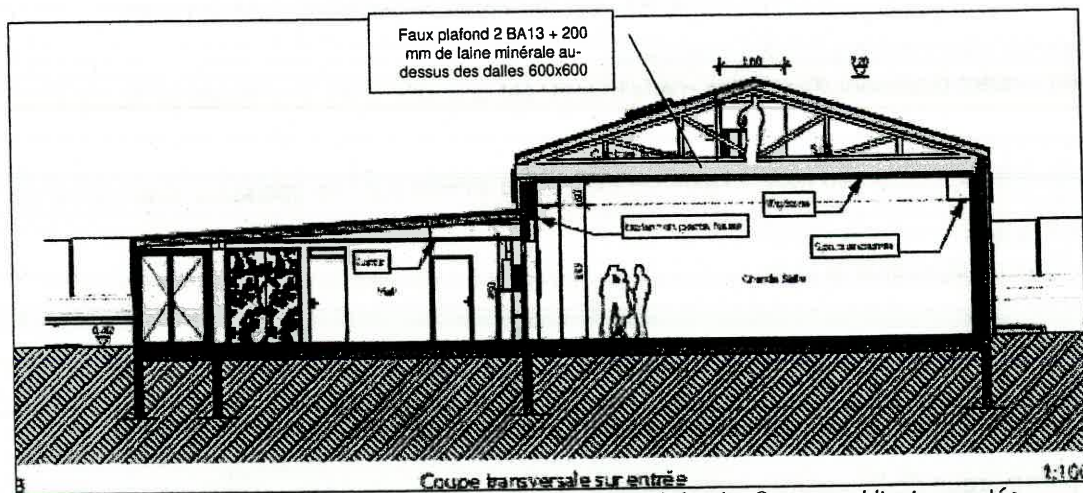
Principe de traitement de la toiture + faux plafond – Coupe architecte annotée
